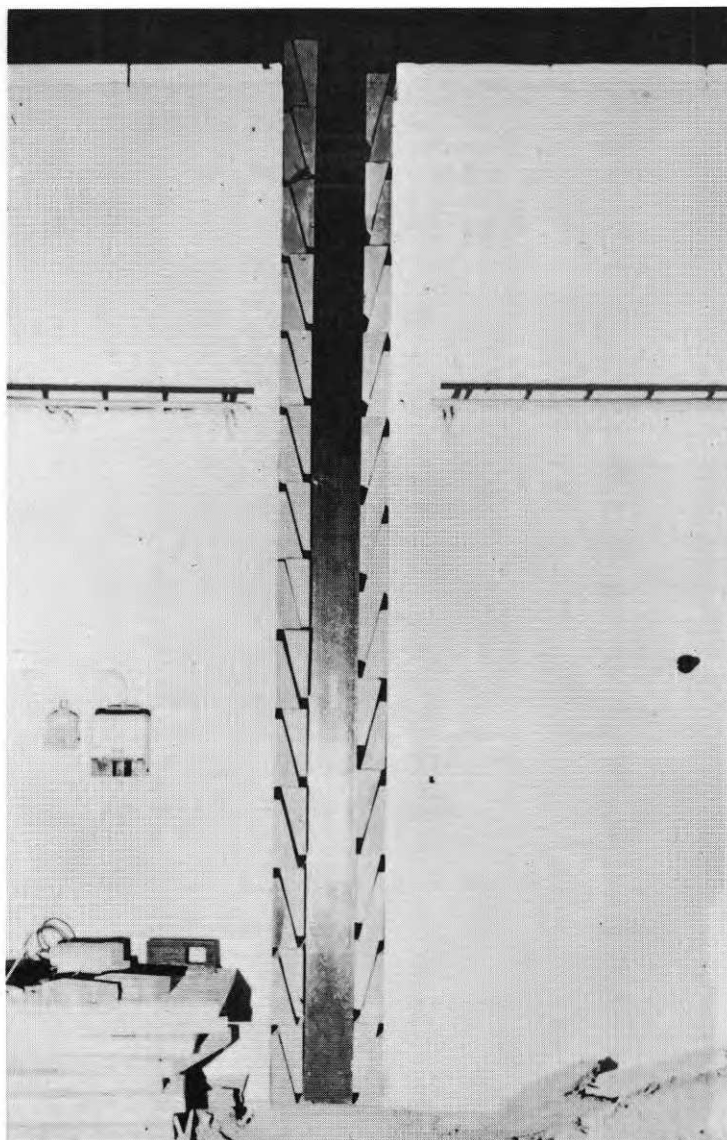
5. Betongkilar mellan provram och flankerande, yttre väggar.
